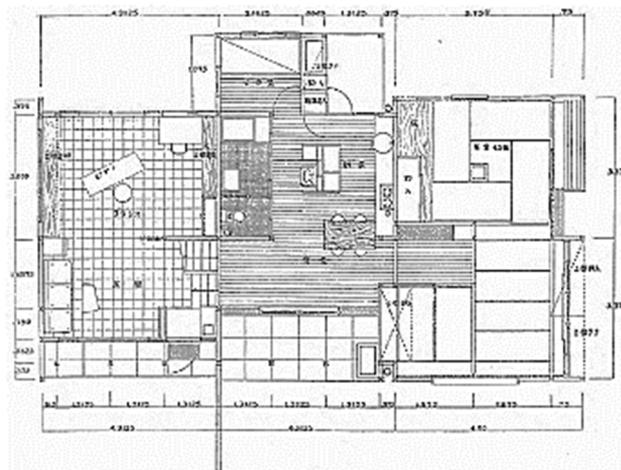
『建築文化』掲載の「住宅 No. 10」(1953) 平面図
